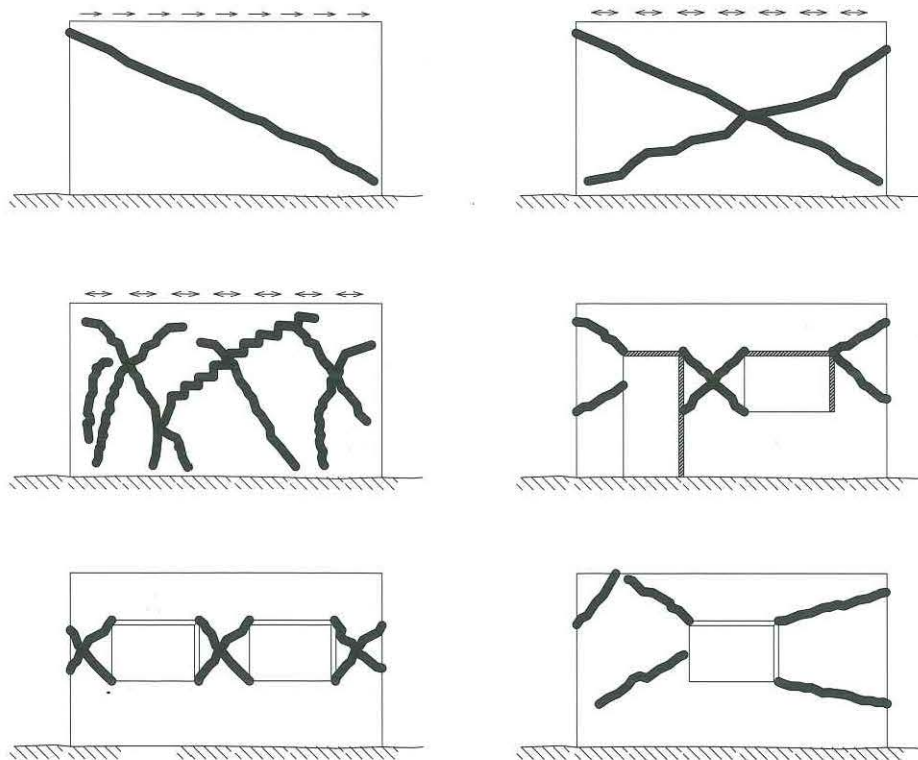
Tipos de fallas en muros de adobe debido a cargas en su plano
